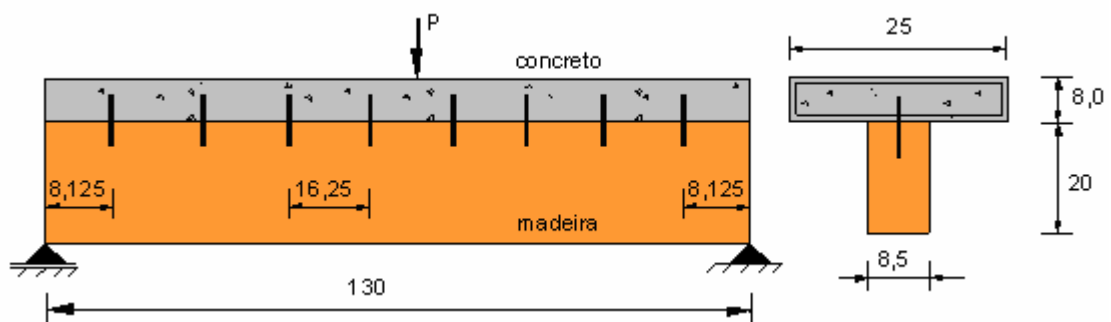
Seção transversal “T” proposta para a viga com conectores “verticais”.
